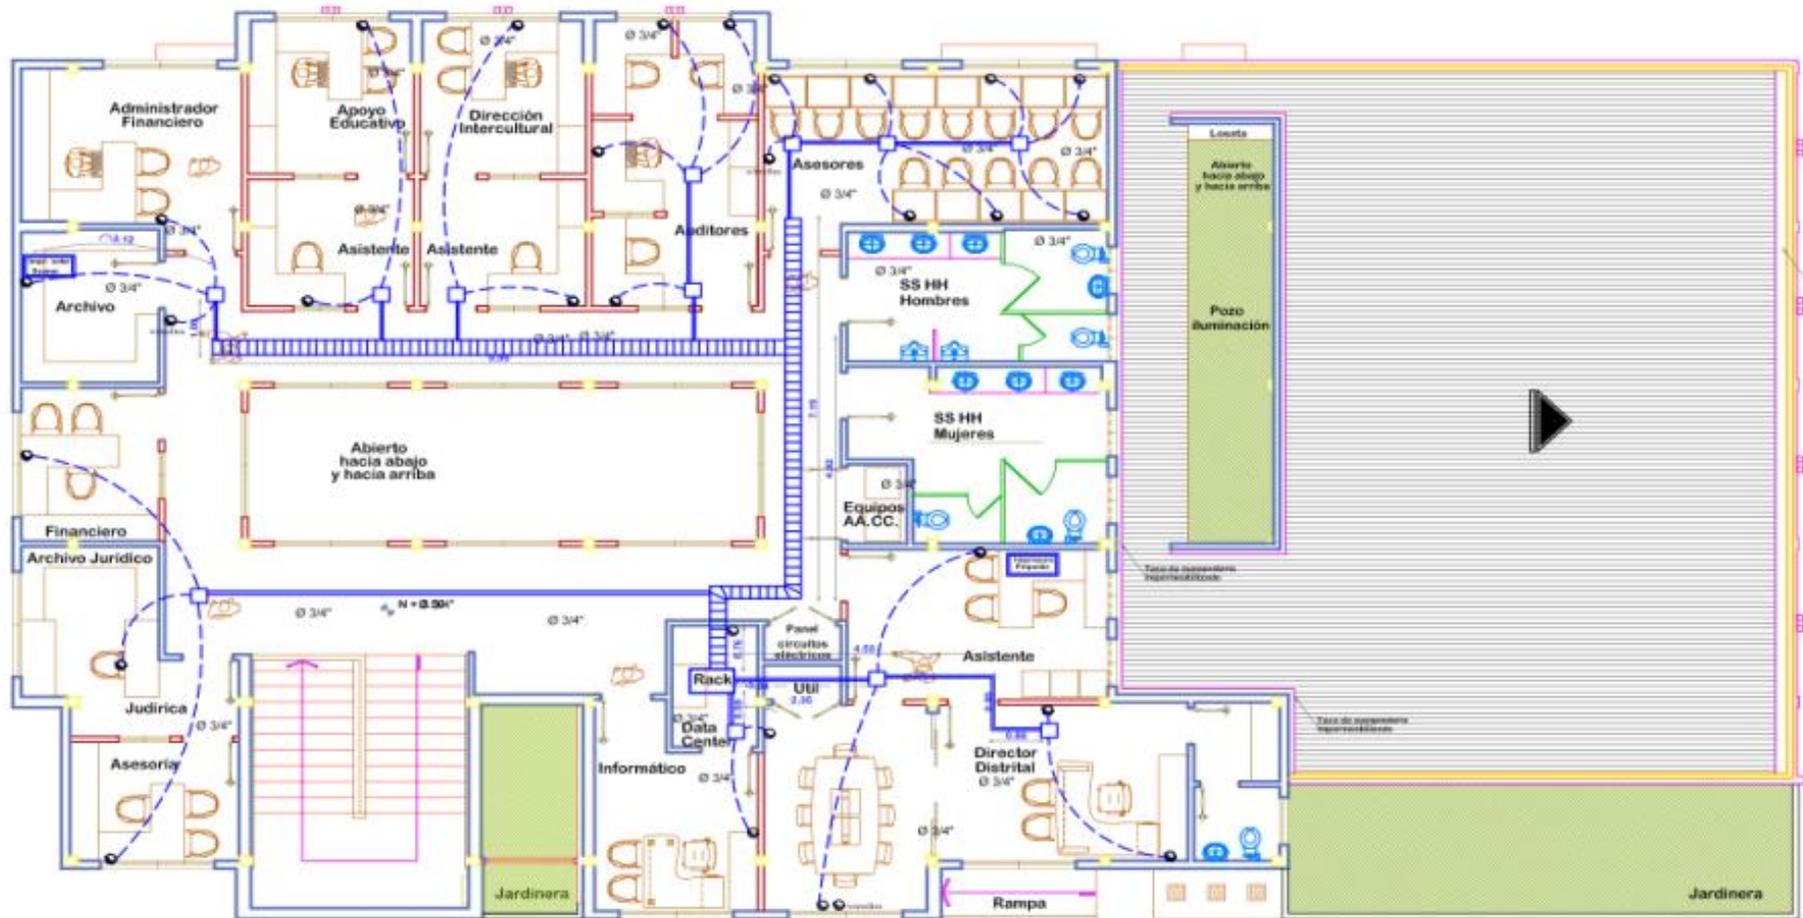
Sistema de Cableado estructurado diseñado de la planta baja de los Distritos de Educación.
